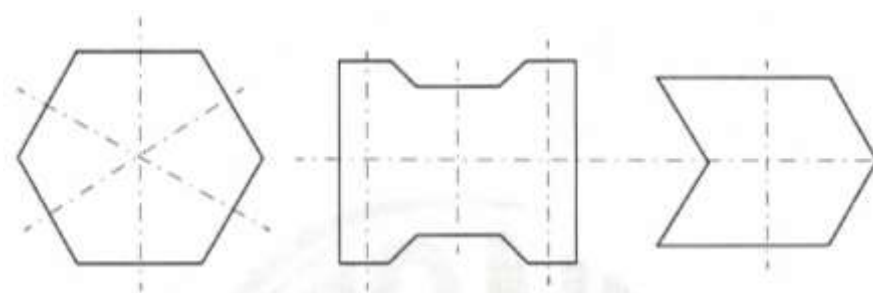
Exemplo de blocos intertravado de concreto tipo II.
